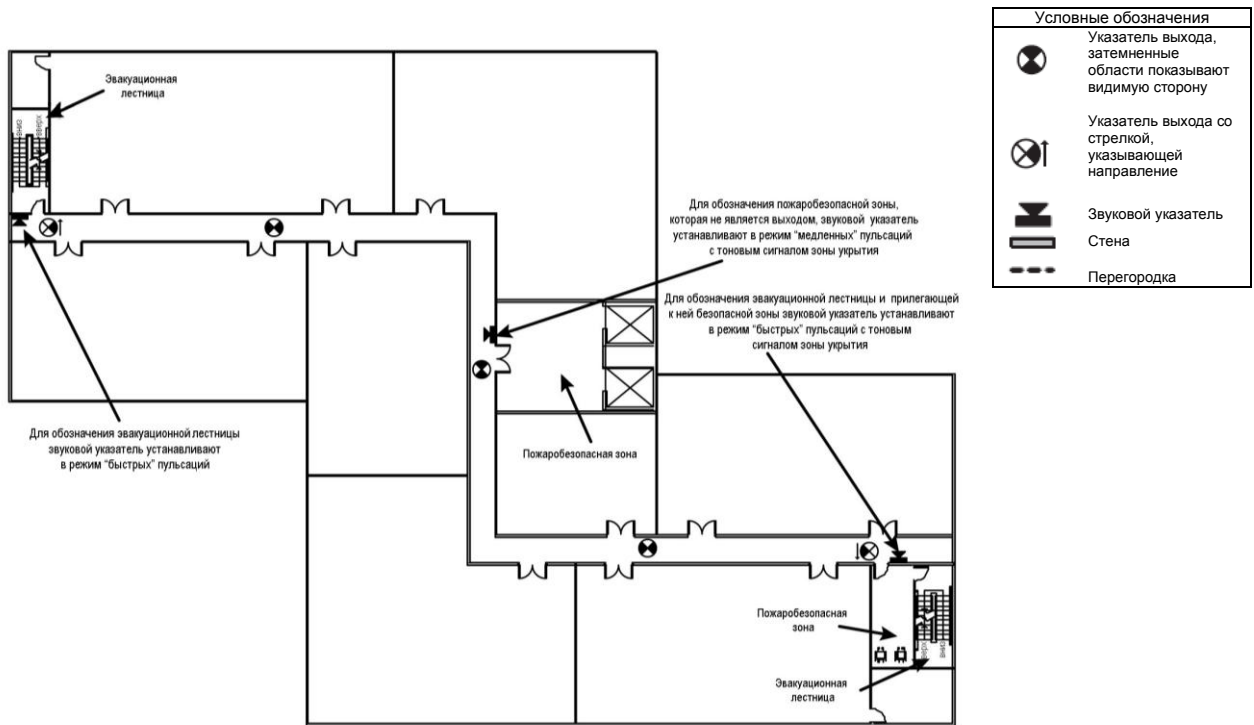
Звуковые указатели установленные по варианту 1 располагаются у выходов на лестницы и у пожаробезопасных зон
